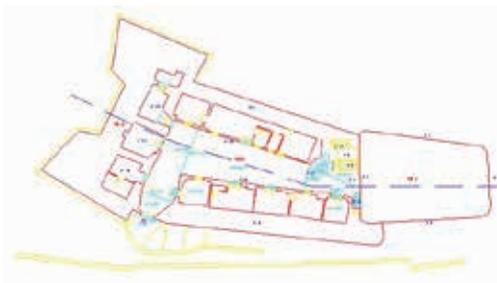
Fuente: Carlos González; Planta del castillo con identificación de Conjuntos estructurales (CE) y Estructuras (E).
